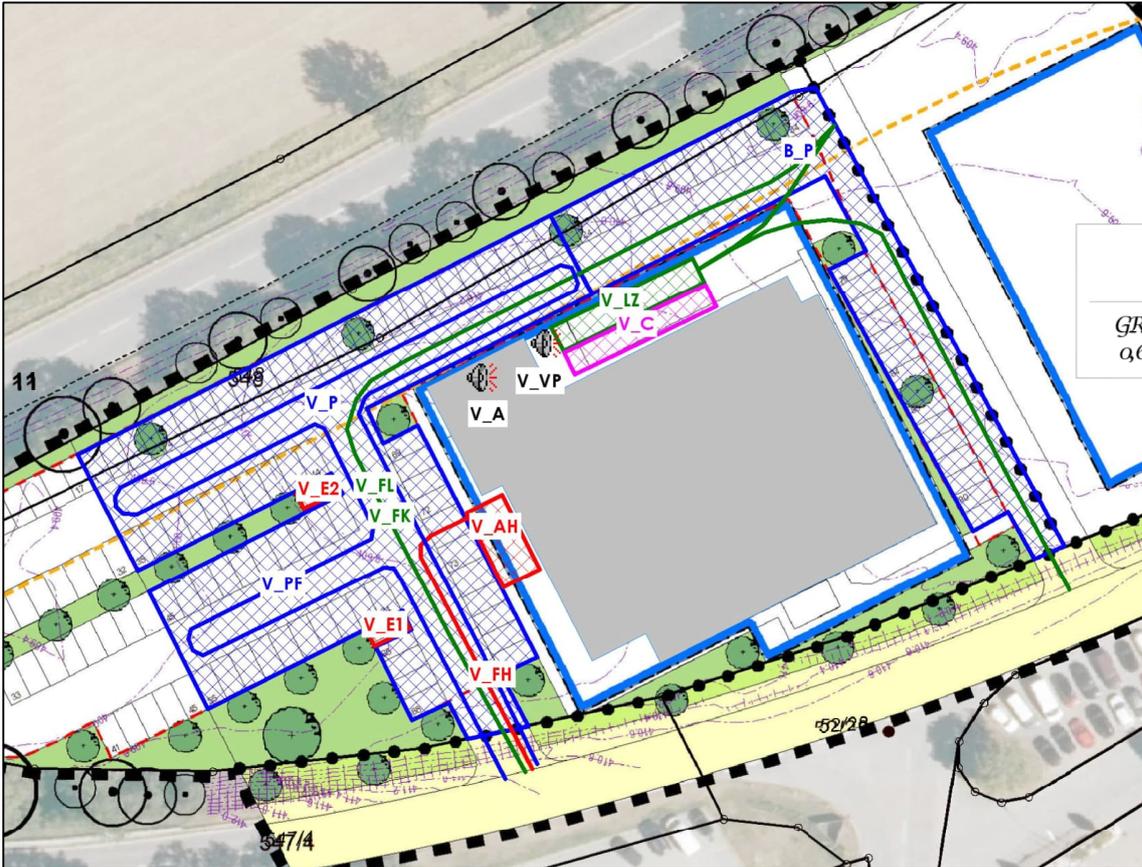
Lageplan mit Darstellung der relevanten Schallquellen – Edeka/Büro
